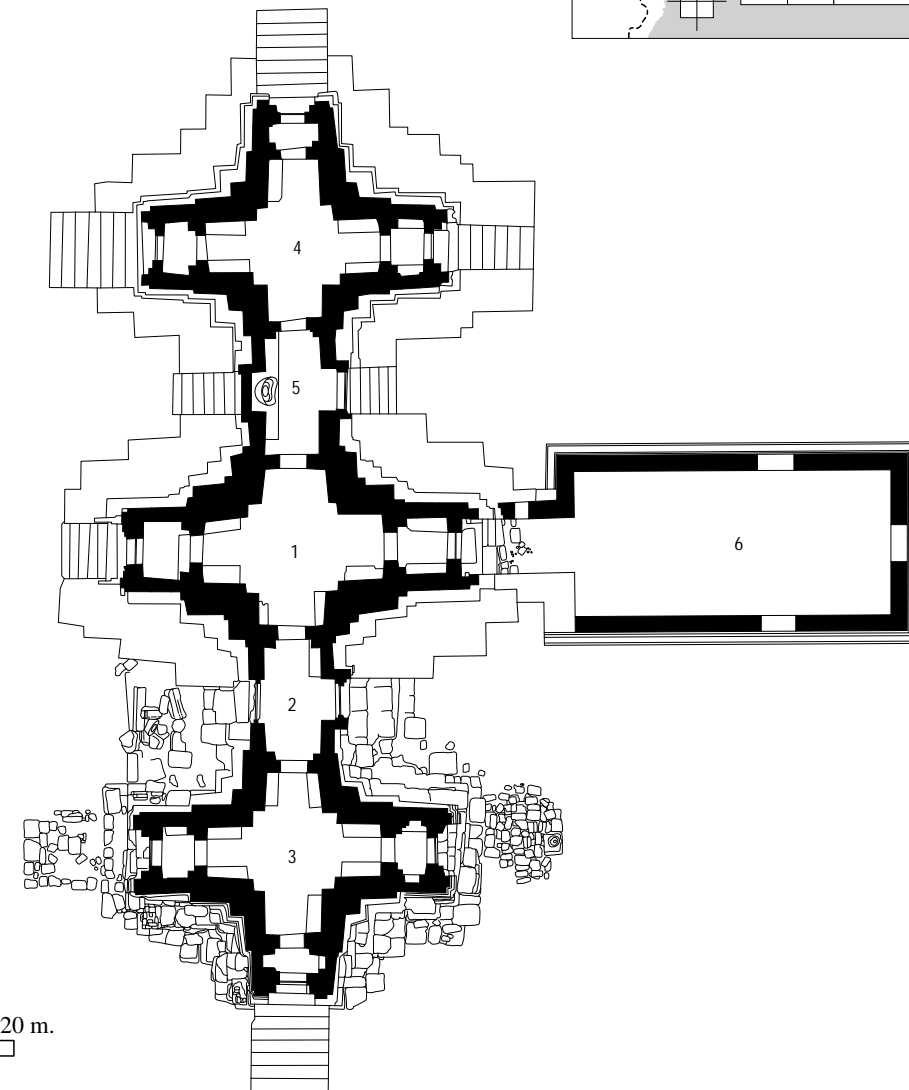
Plan d'ensemble du Prang Sam Yod
